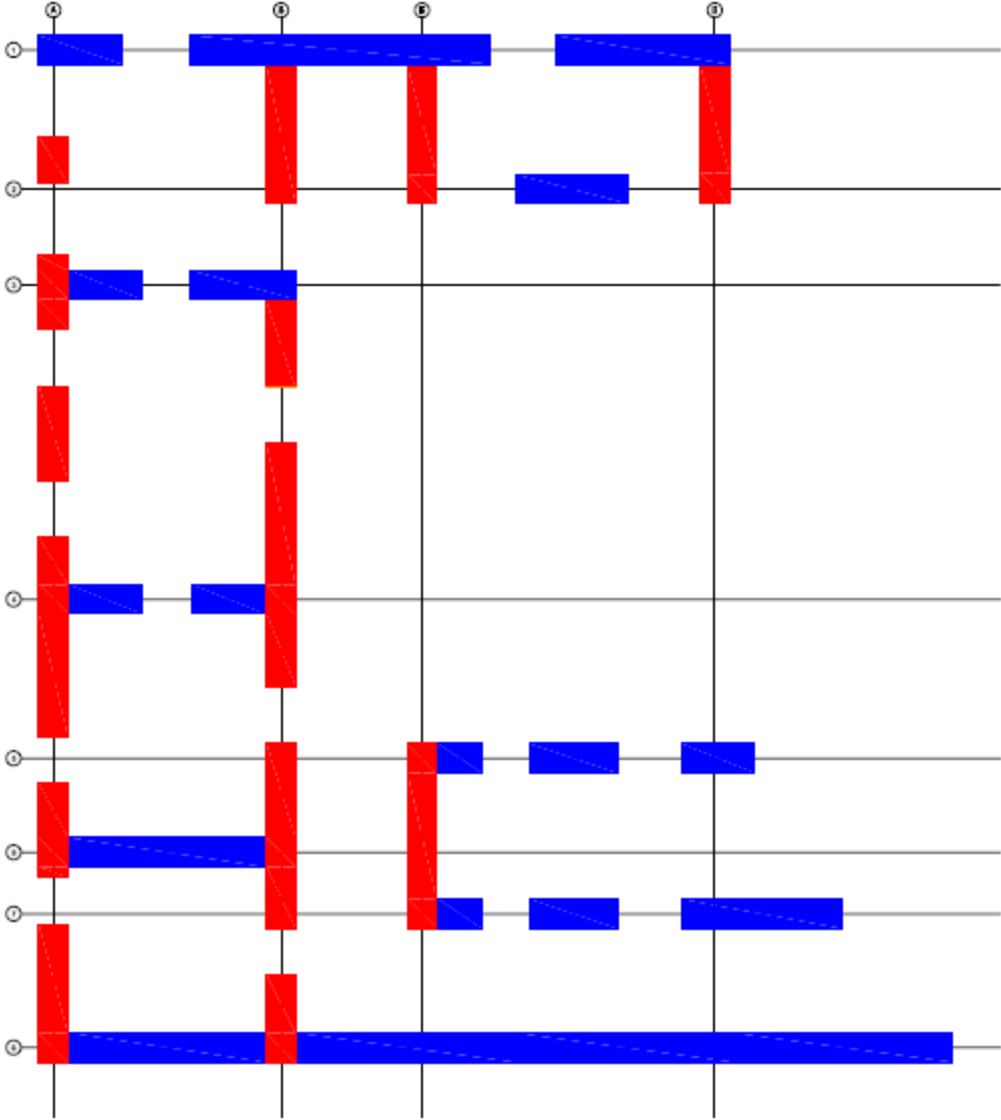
Configuración estructural modificada en planta de muros edificación 2.
